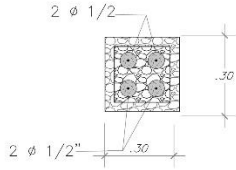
Detalle de zapata con columna en ladrillo ecológico
